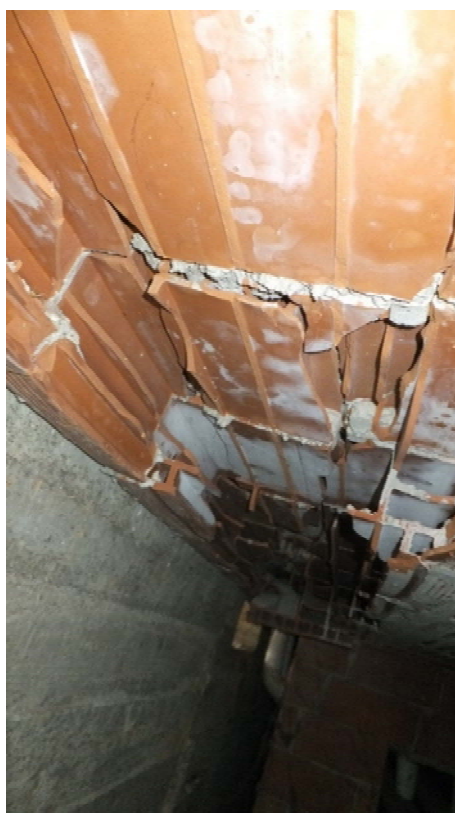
Vista vano da chiudere su parete a due teste, piano interrato
